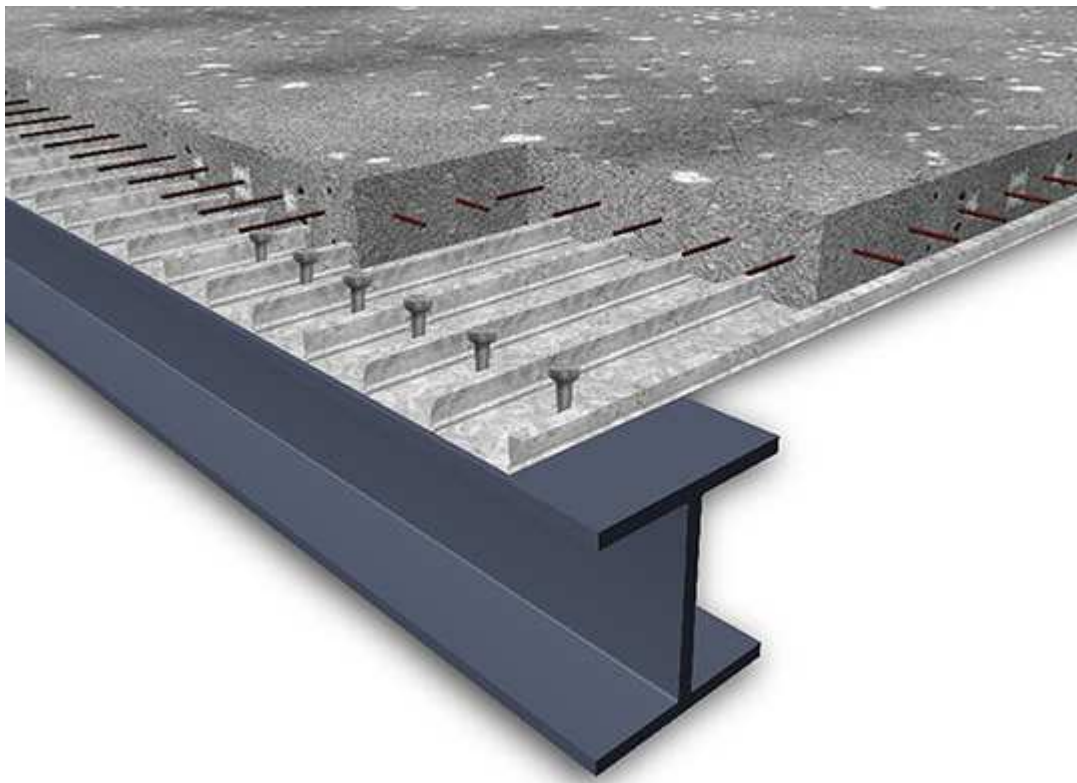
Esquema de losa mixta. Fuente: constructalia.com
